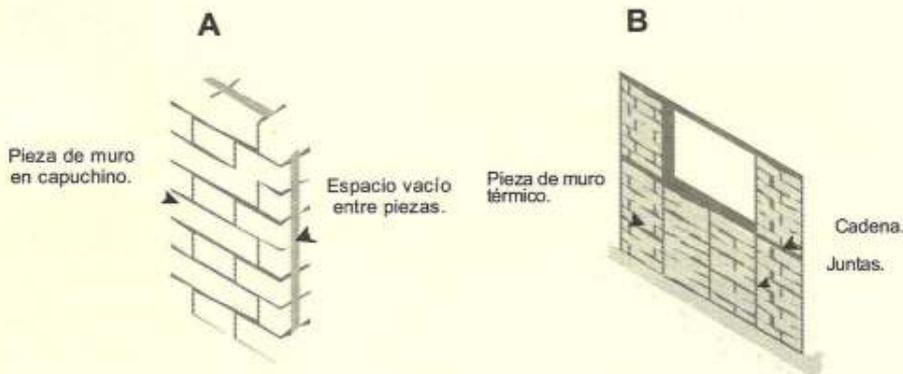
Muro térmico. En gráfico A, se muestra un módulo por separado, en gráfico B, se muestra la construcción de un muro modular con los elementos prefabricados.
